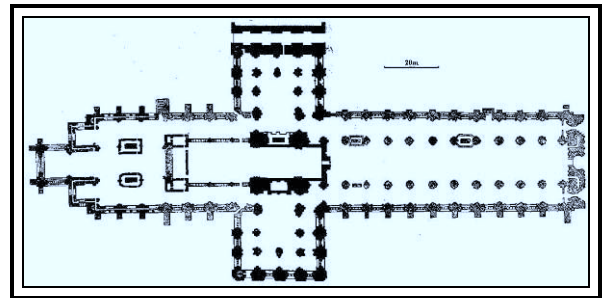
Catedral de Winchester (Reino Unido): planta
